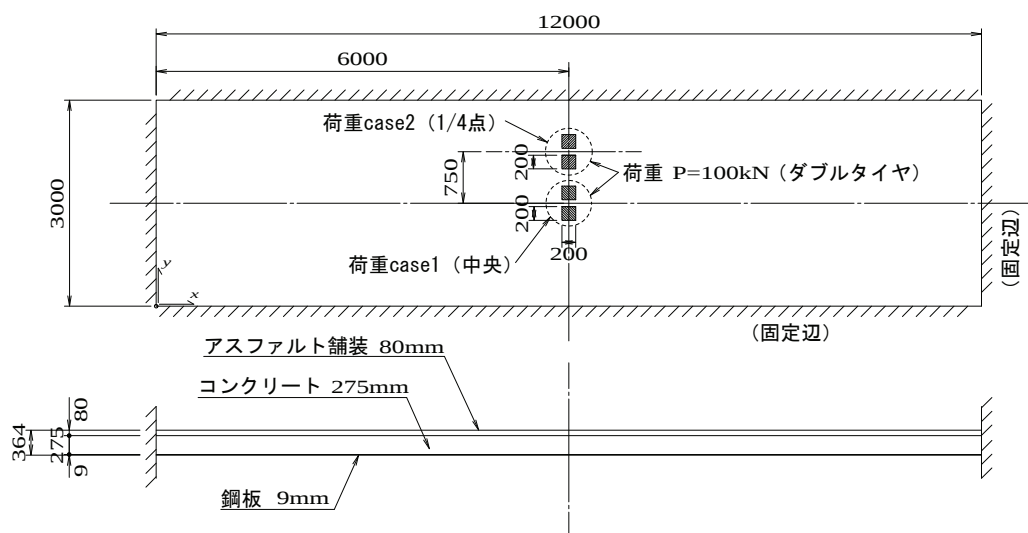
鋼・コンクリート合成床版の計算モデル (単位: mm)
